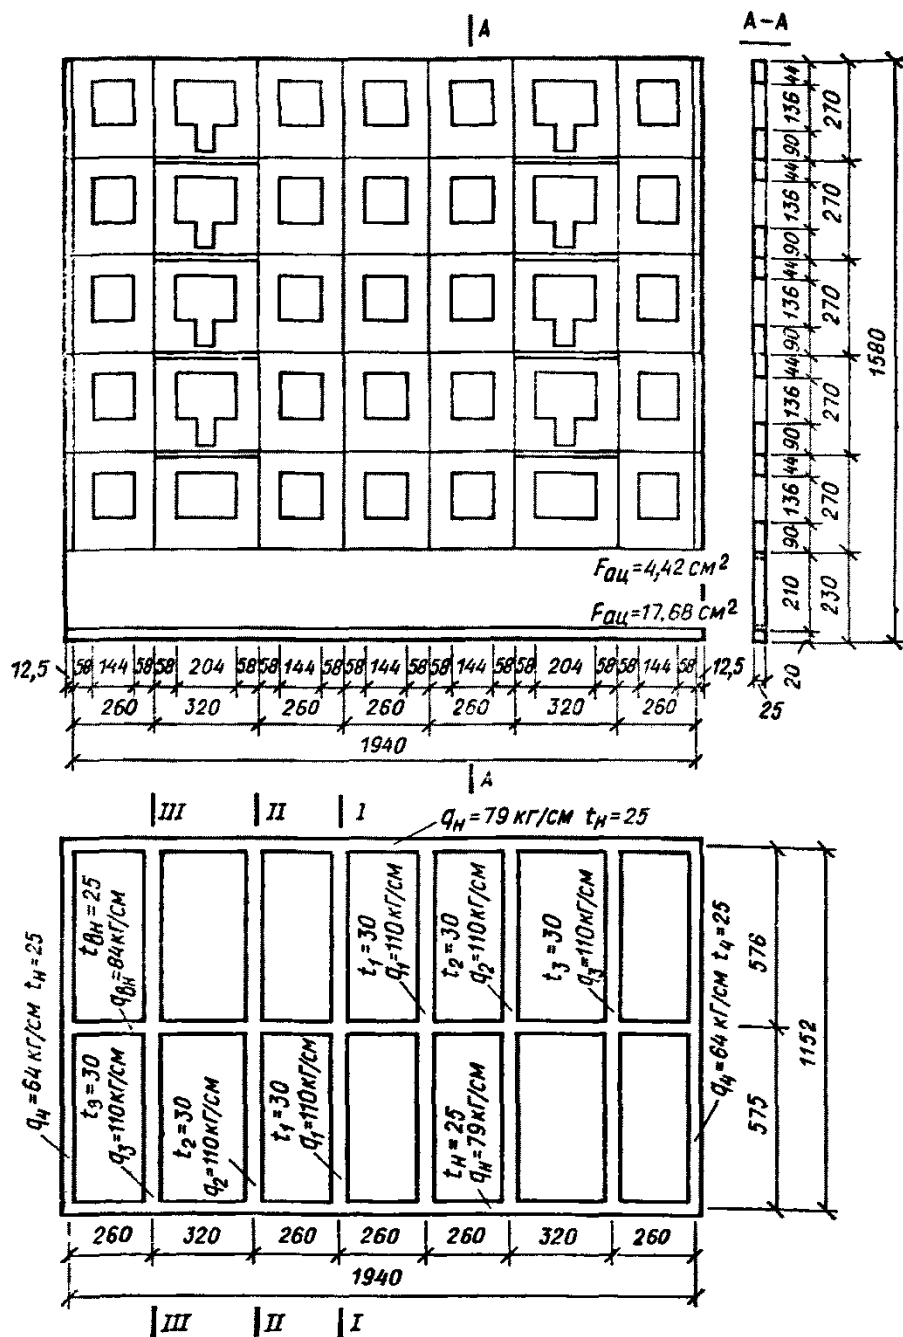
Фасад крупнопанельного здания, план фундаментов
